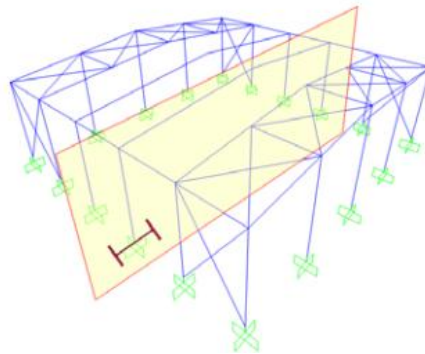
Pilares en fachada lateral. [5. Construcción T6, 14/15].
